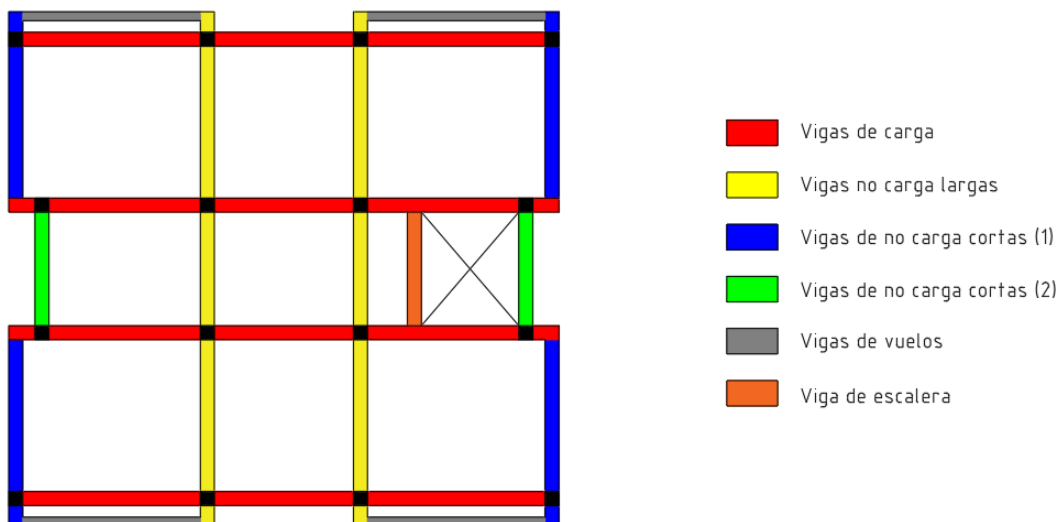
Tipos de vigas de la estructura para realizar las secciones en GiD.
